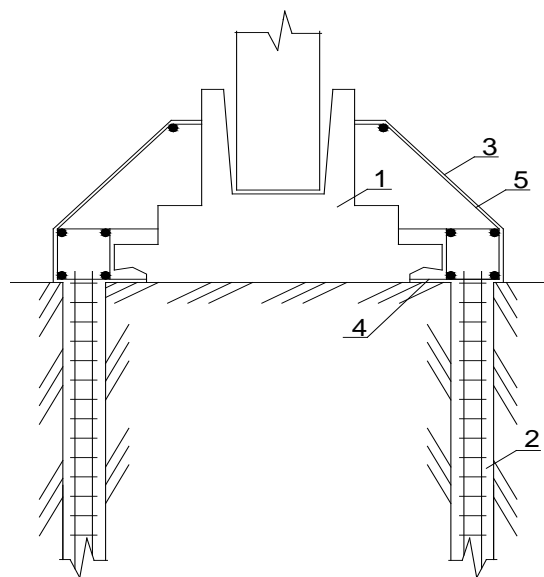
Усиление столбчатых фундаментов буронабивными сваями:
